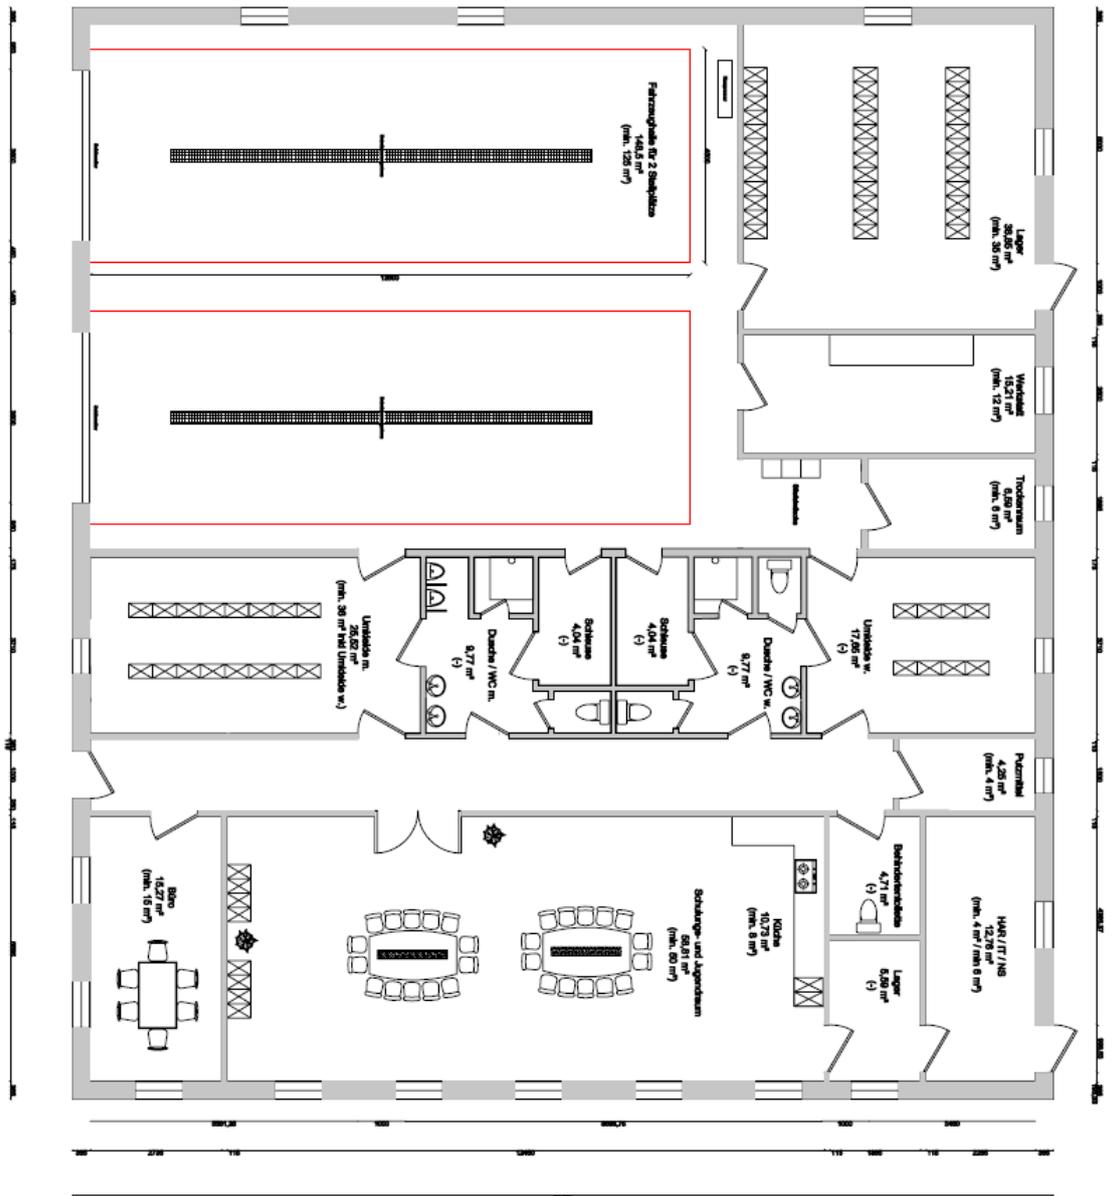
Grundriss Musterhaus. Quelle: www.regierung-mv.de.
